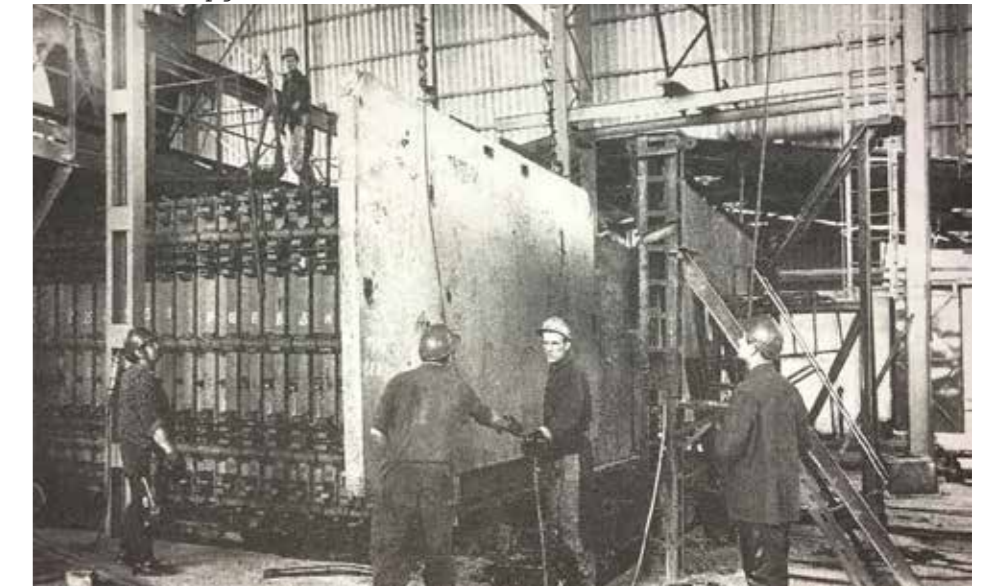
Trabajadores Transportando los paneles de hormigón (Blokowiska pg.63) 1967
